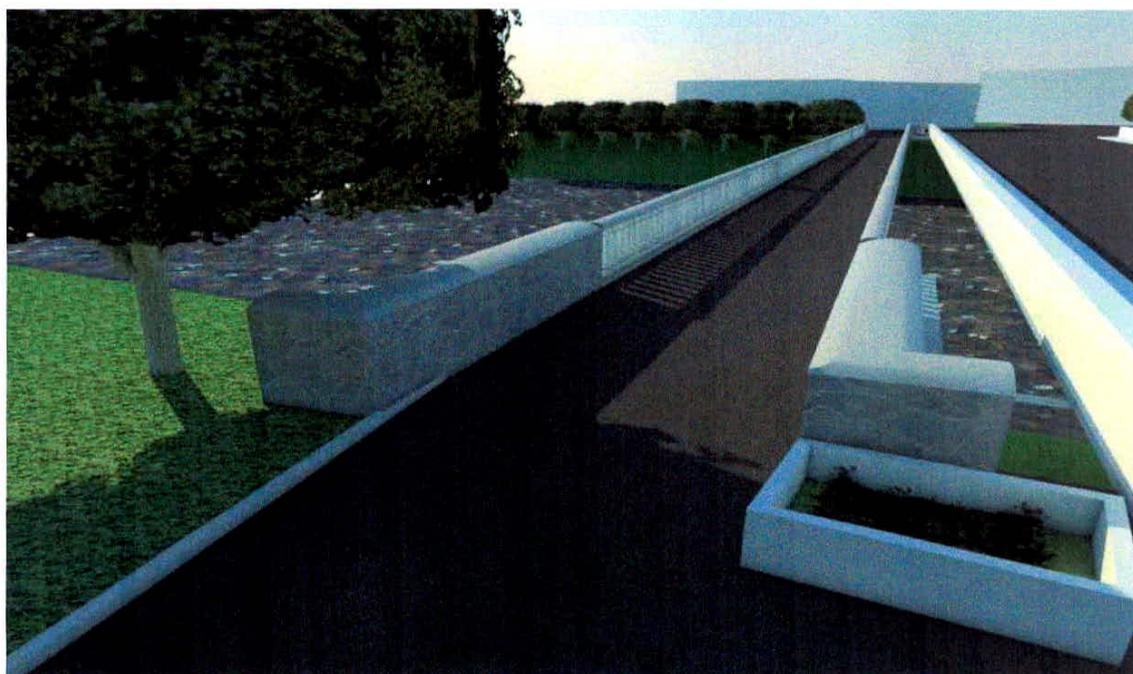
Proposta de restauração para a Ponte dos Boiadeiros
